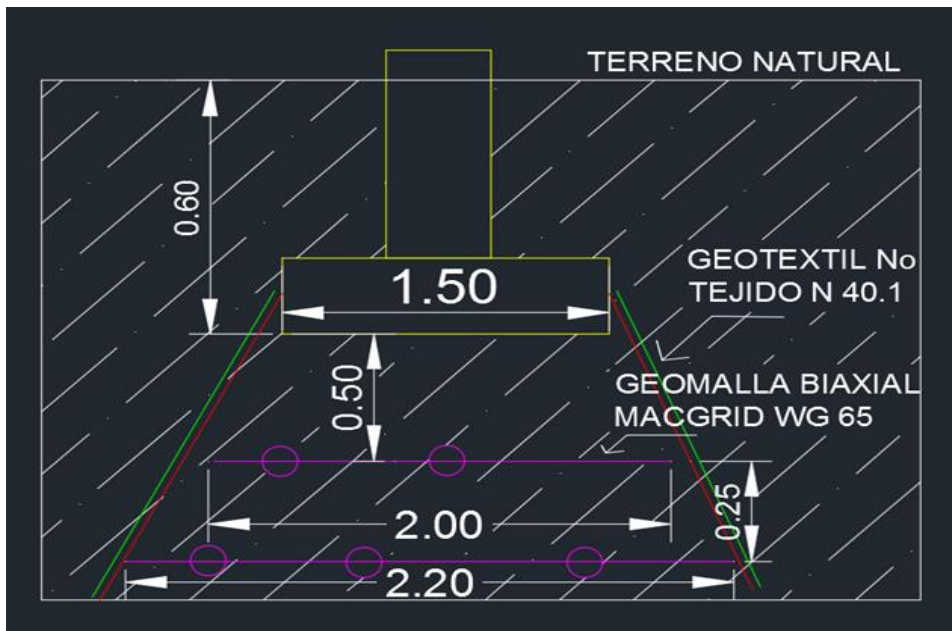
Diseño de cimentación con refuerzo de geomallas para zapata N°2
